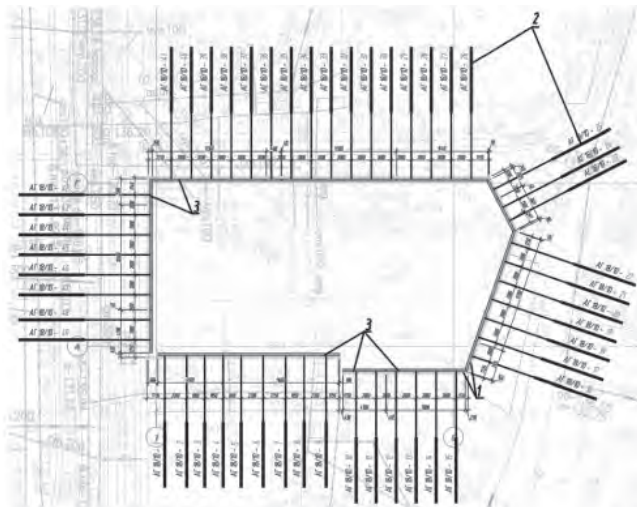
Схема размещения грунтовых анкеров ЭРТ ограждения котлована: 1 – буринъекционные сваи ЭРТ; 2 – грунтовые анкера ЭРТ первого уровня; 3 – монолитный железобетонный обвязочный пояс
